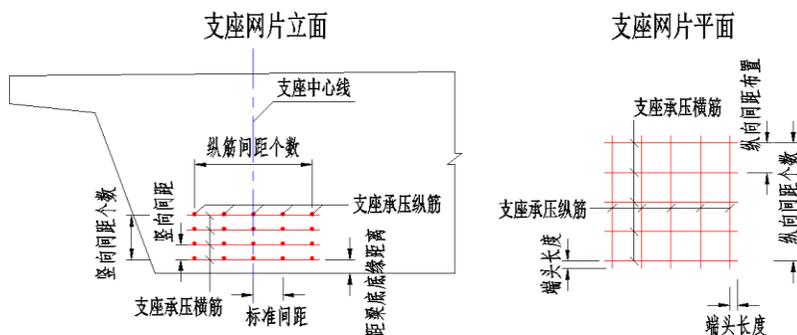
边跨现浇段横梁钢筋-支座网片示意图
